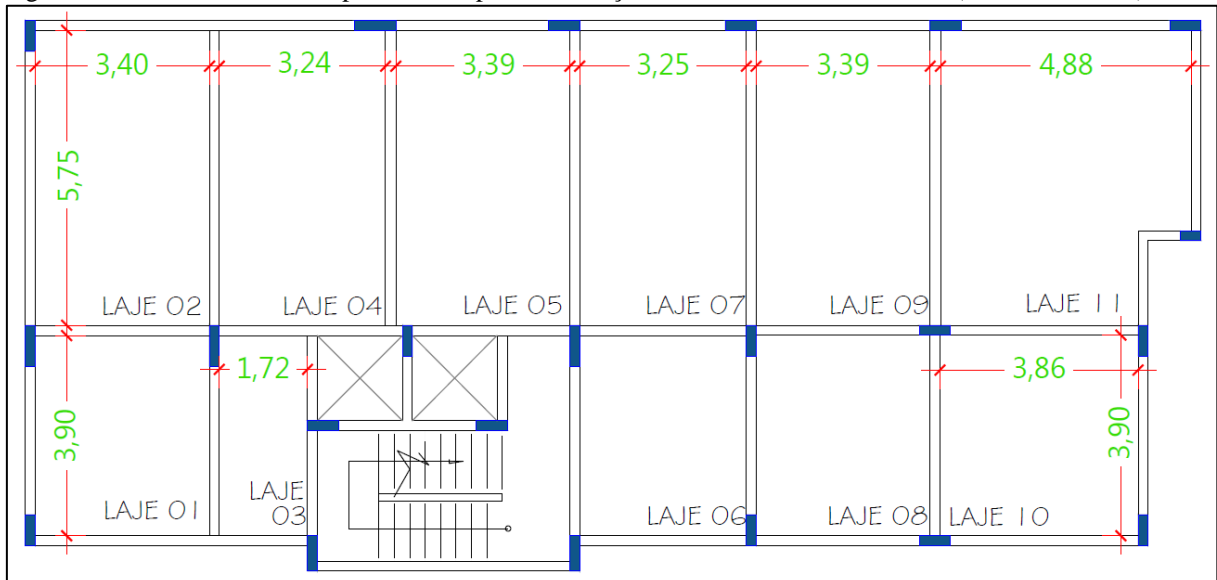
Planta de fôrma do pavimento tipo com vedações verticais internas em *drywall* (cotas em metros)
